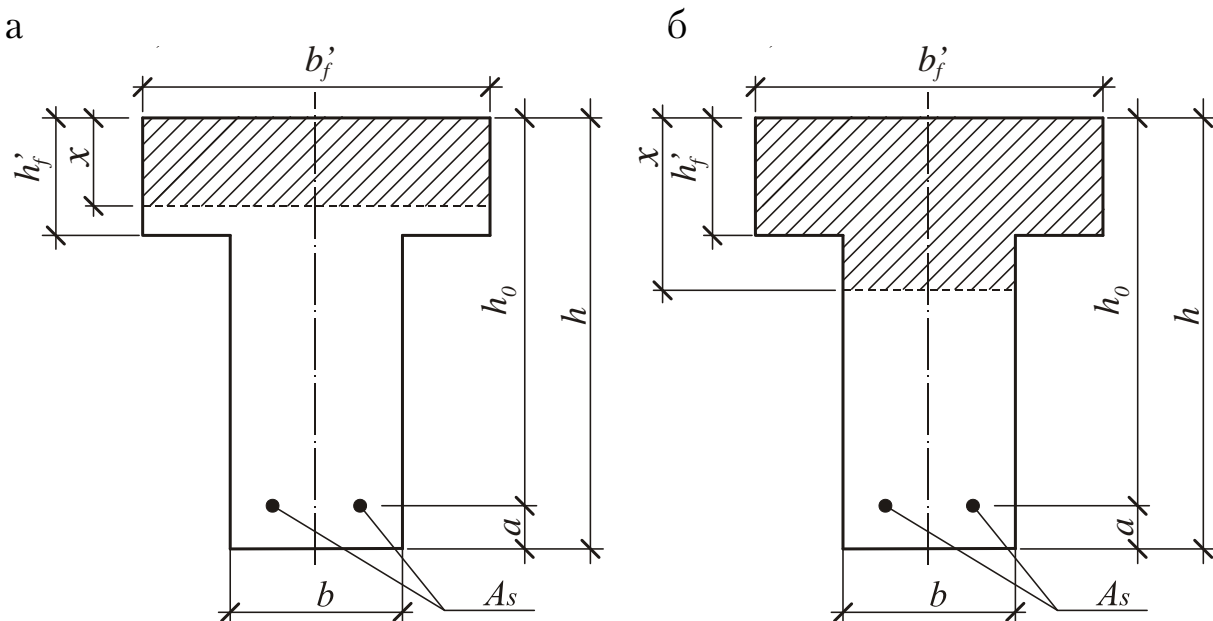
Расчетное поперечное сечение изгибаемого железобетонного элемента таврового профиля с одиночным армированием:
